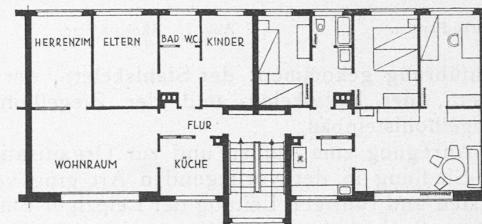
Grundriss Typ des Eisenbeton-Baublocks. — 1 : 300.
